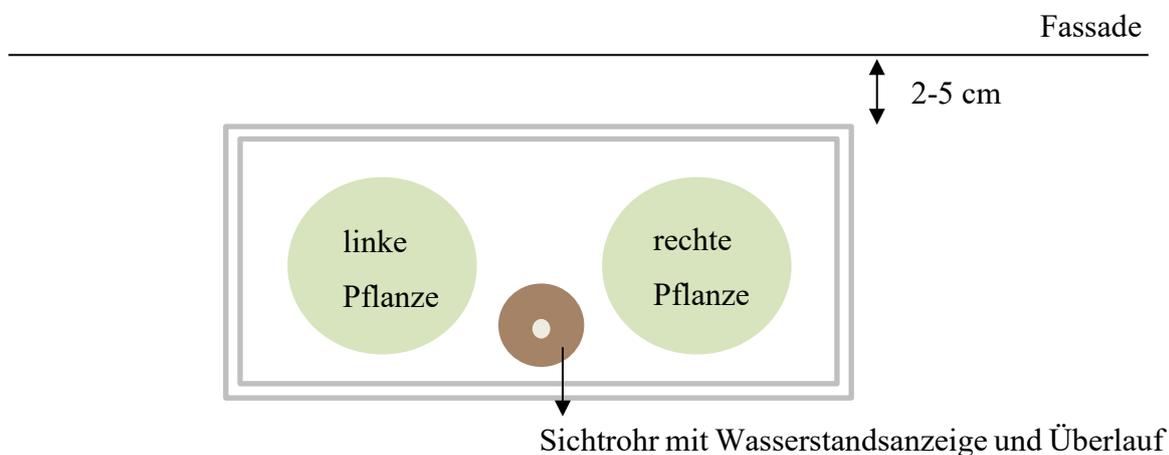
Grundriss des Pflanztrögs (nicht Maßstabtreu)
